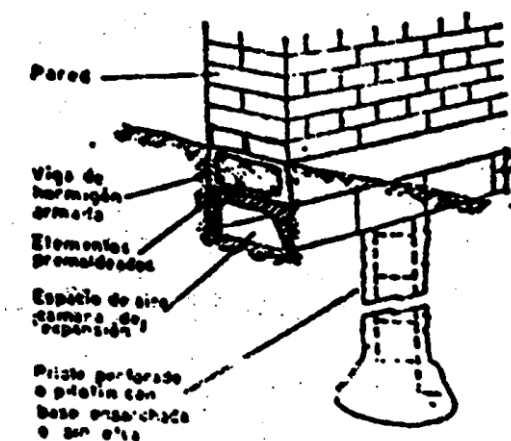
Sistema de cimentación superficial en suelos de alta expansividad.
